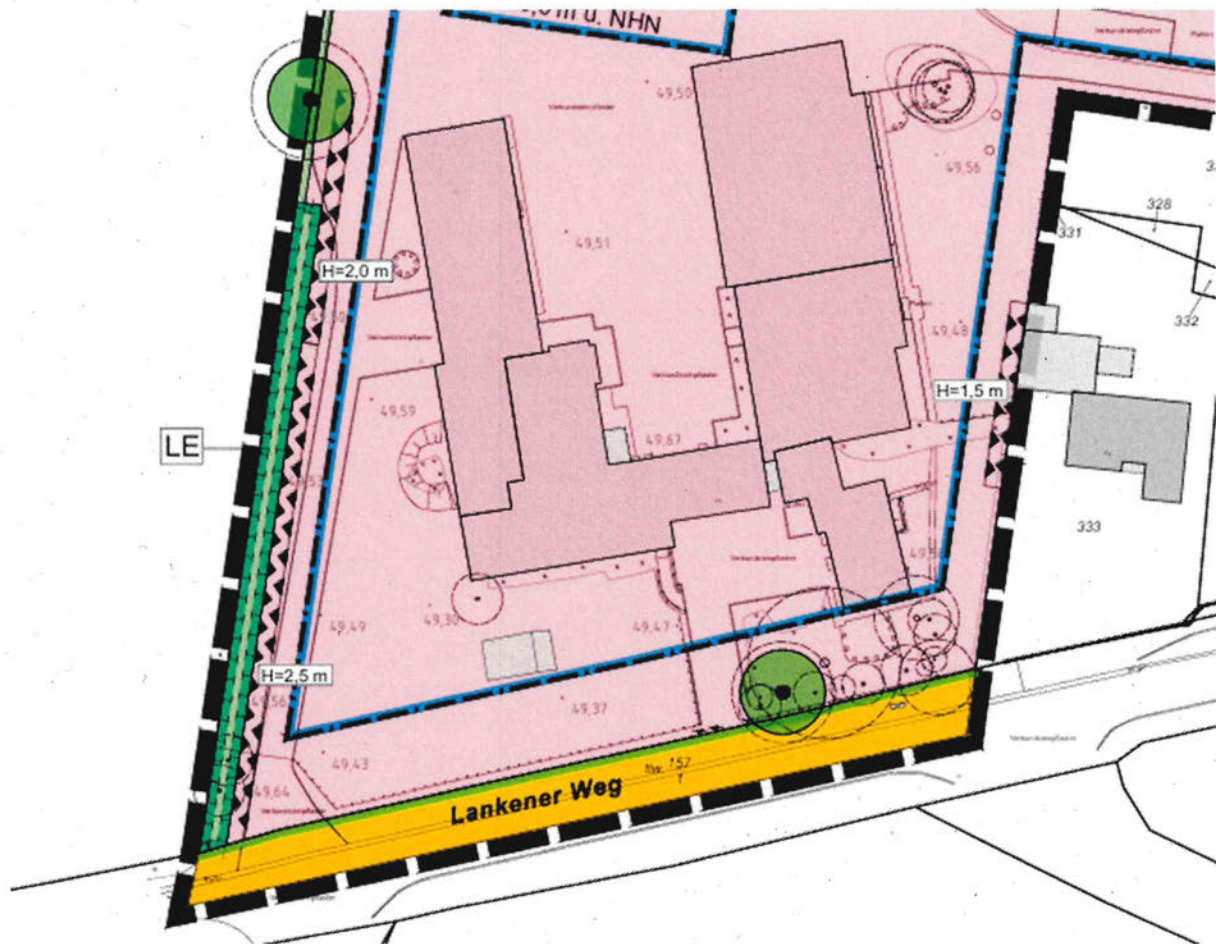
Lärmschutzbereiche aus Planzeichnung\_2025\_04\_14
